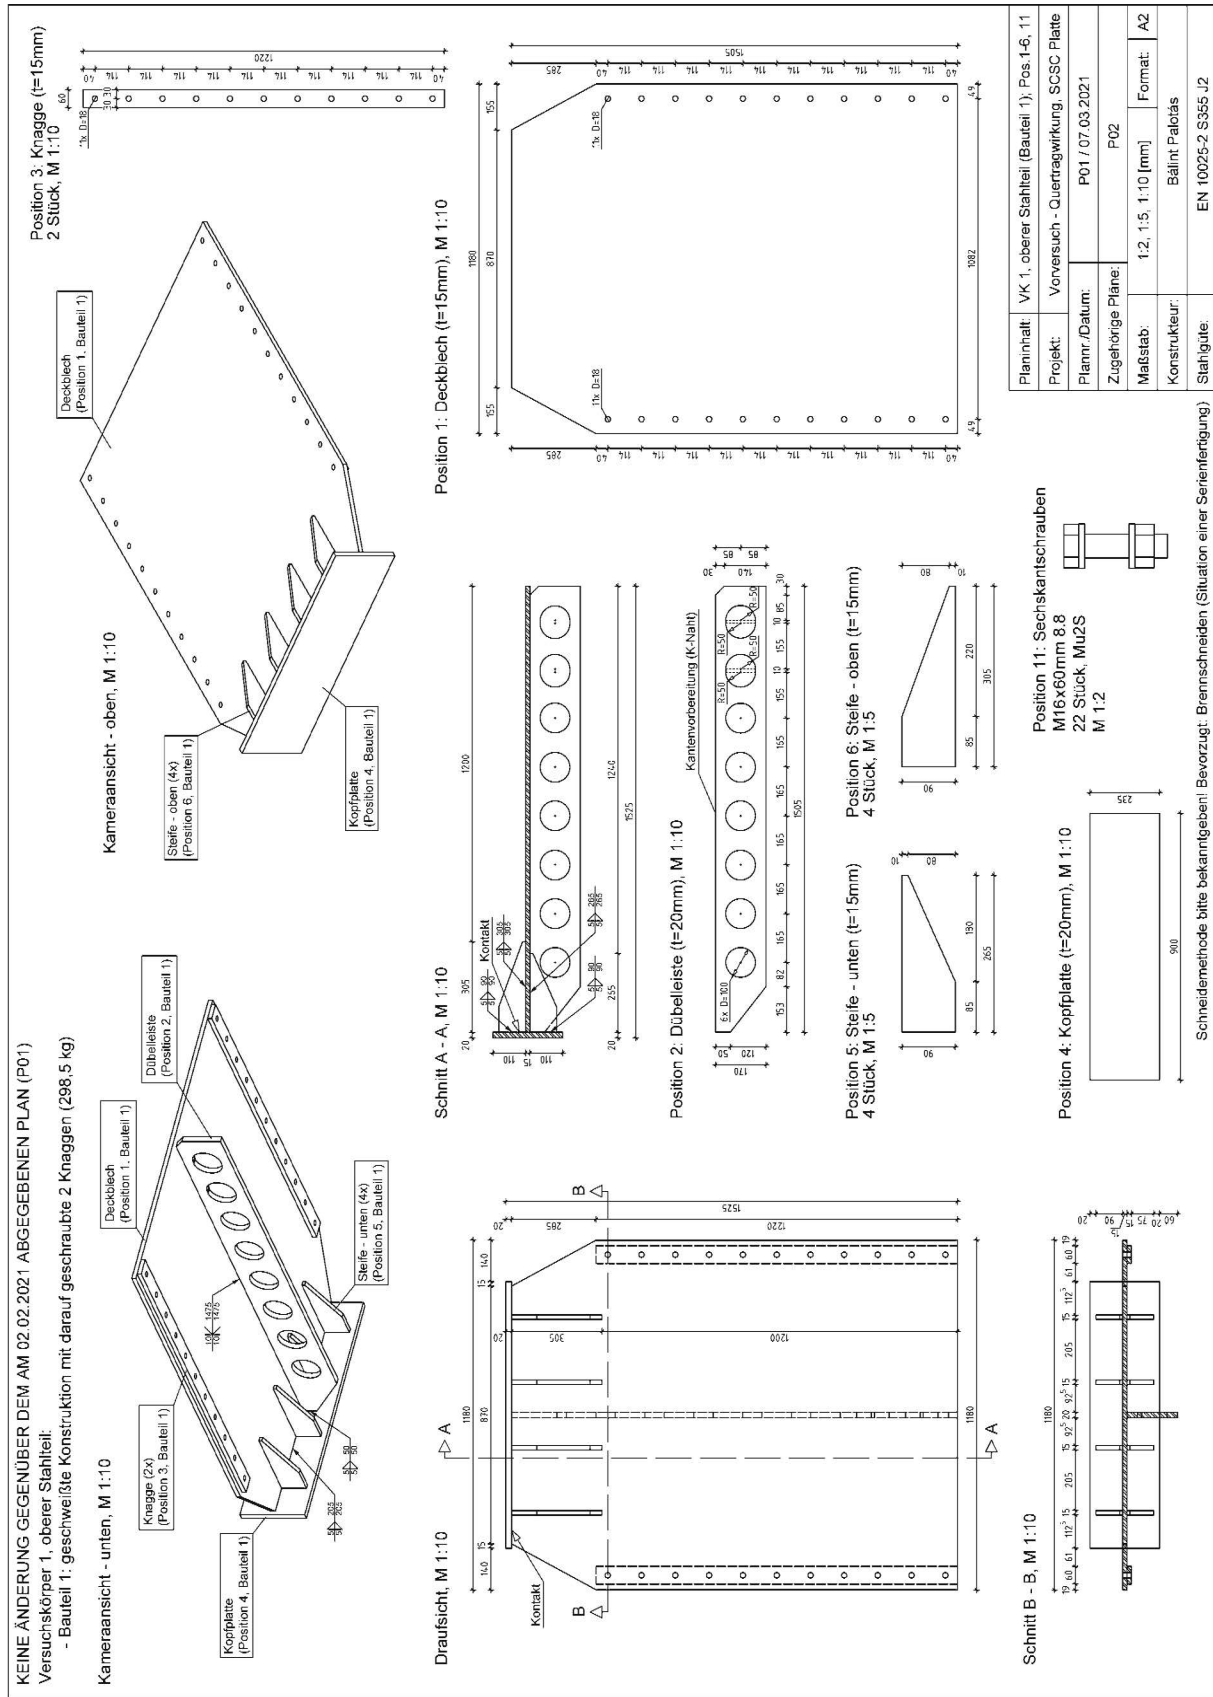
Werkstattplan-P01 des Versuchskörpertyps-VK1; Quelle: TU Wien Institut für Tragkonstruktionen Forschungsbereich für Stahlbau
